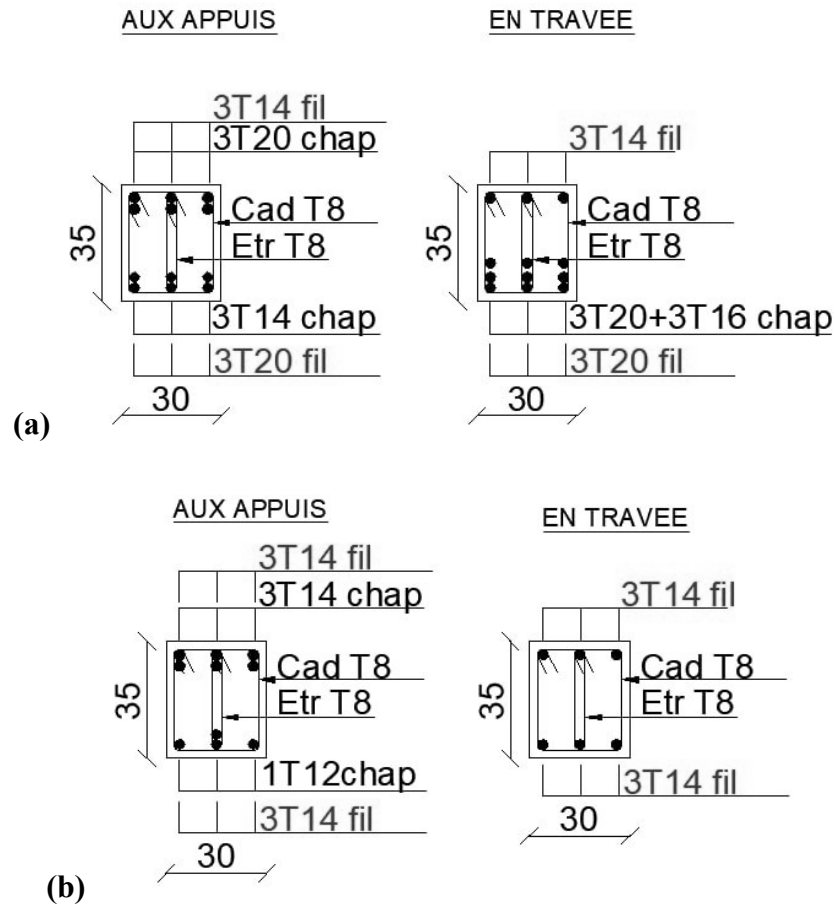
Schéma de ferrailages des poutres secondaires 30x35 cm ; (a) liée aux voiles et (b) non liée aux voiles
